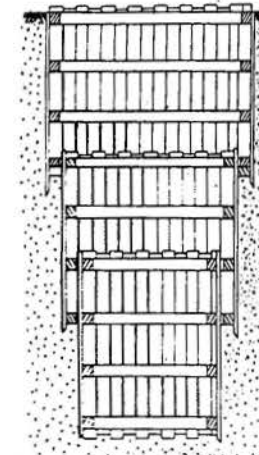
Vista de un elemento de la fortificación de hincado.
